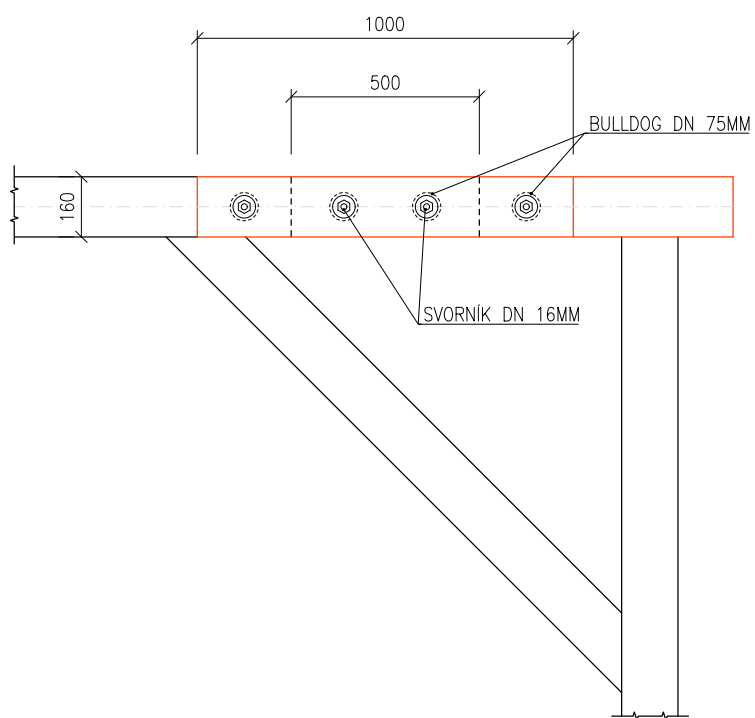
DETAIL PLÁTOVÁNÍ KROKVÍ NA POZEDNICI :
